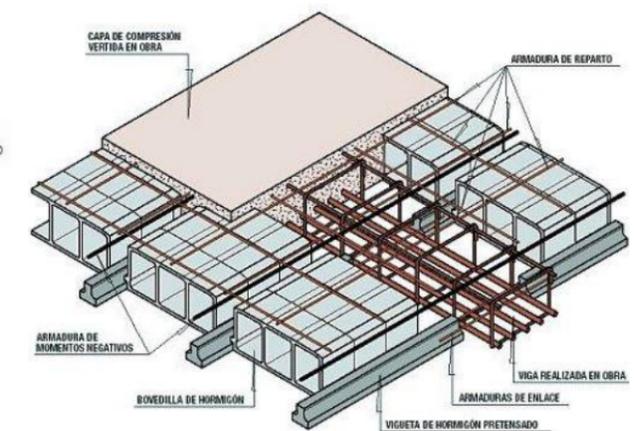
Perspectiva conjunto forjado unidireccional de viguetas pretensadas semirresistentes y bovedillas de hormigón
